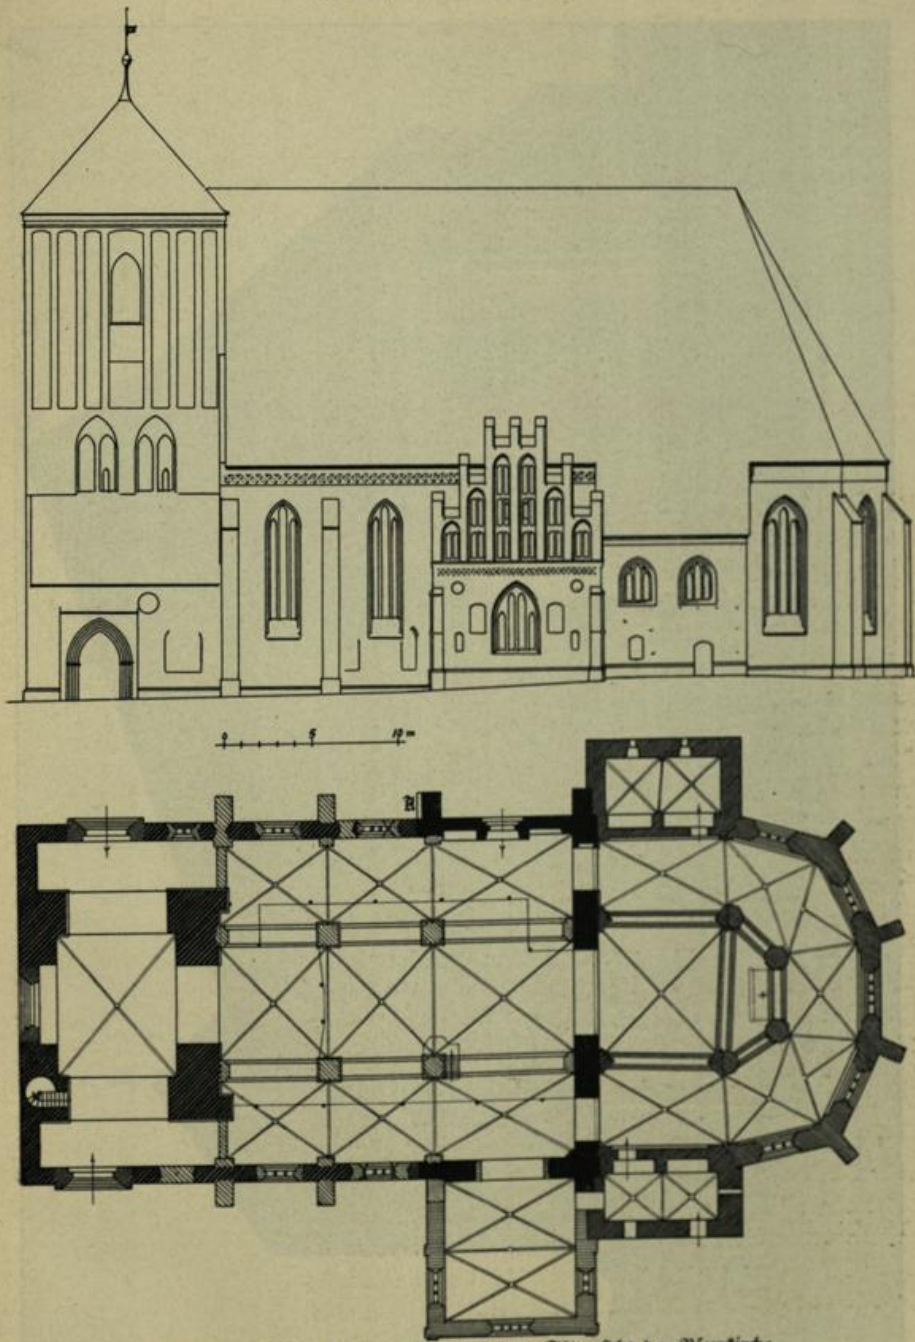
Wusterhausen. Grundriß und Südansicht der Pfarrkirche.
